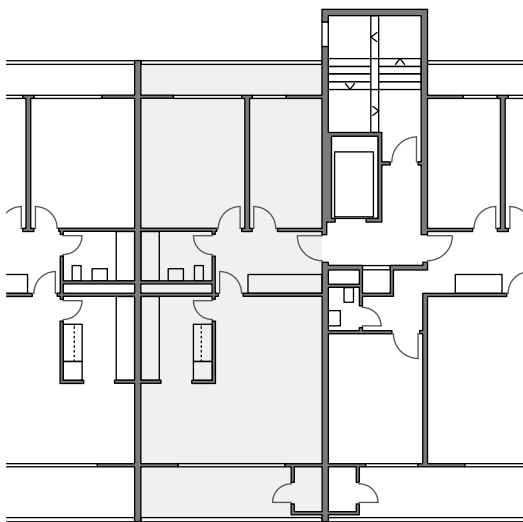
Typengrundriss 3-Zimmerwohnung
